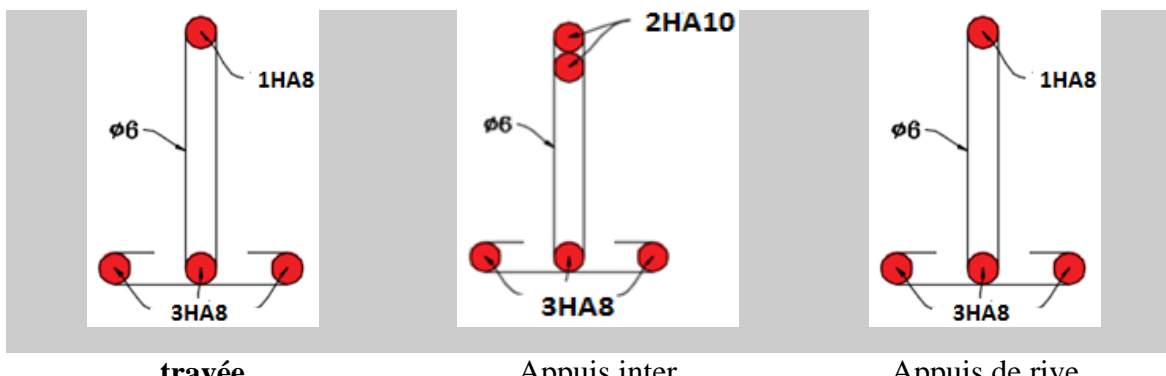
Schémas de ferrailage des poutrelles du NIV+1.02
